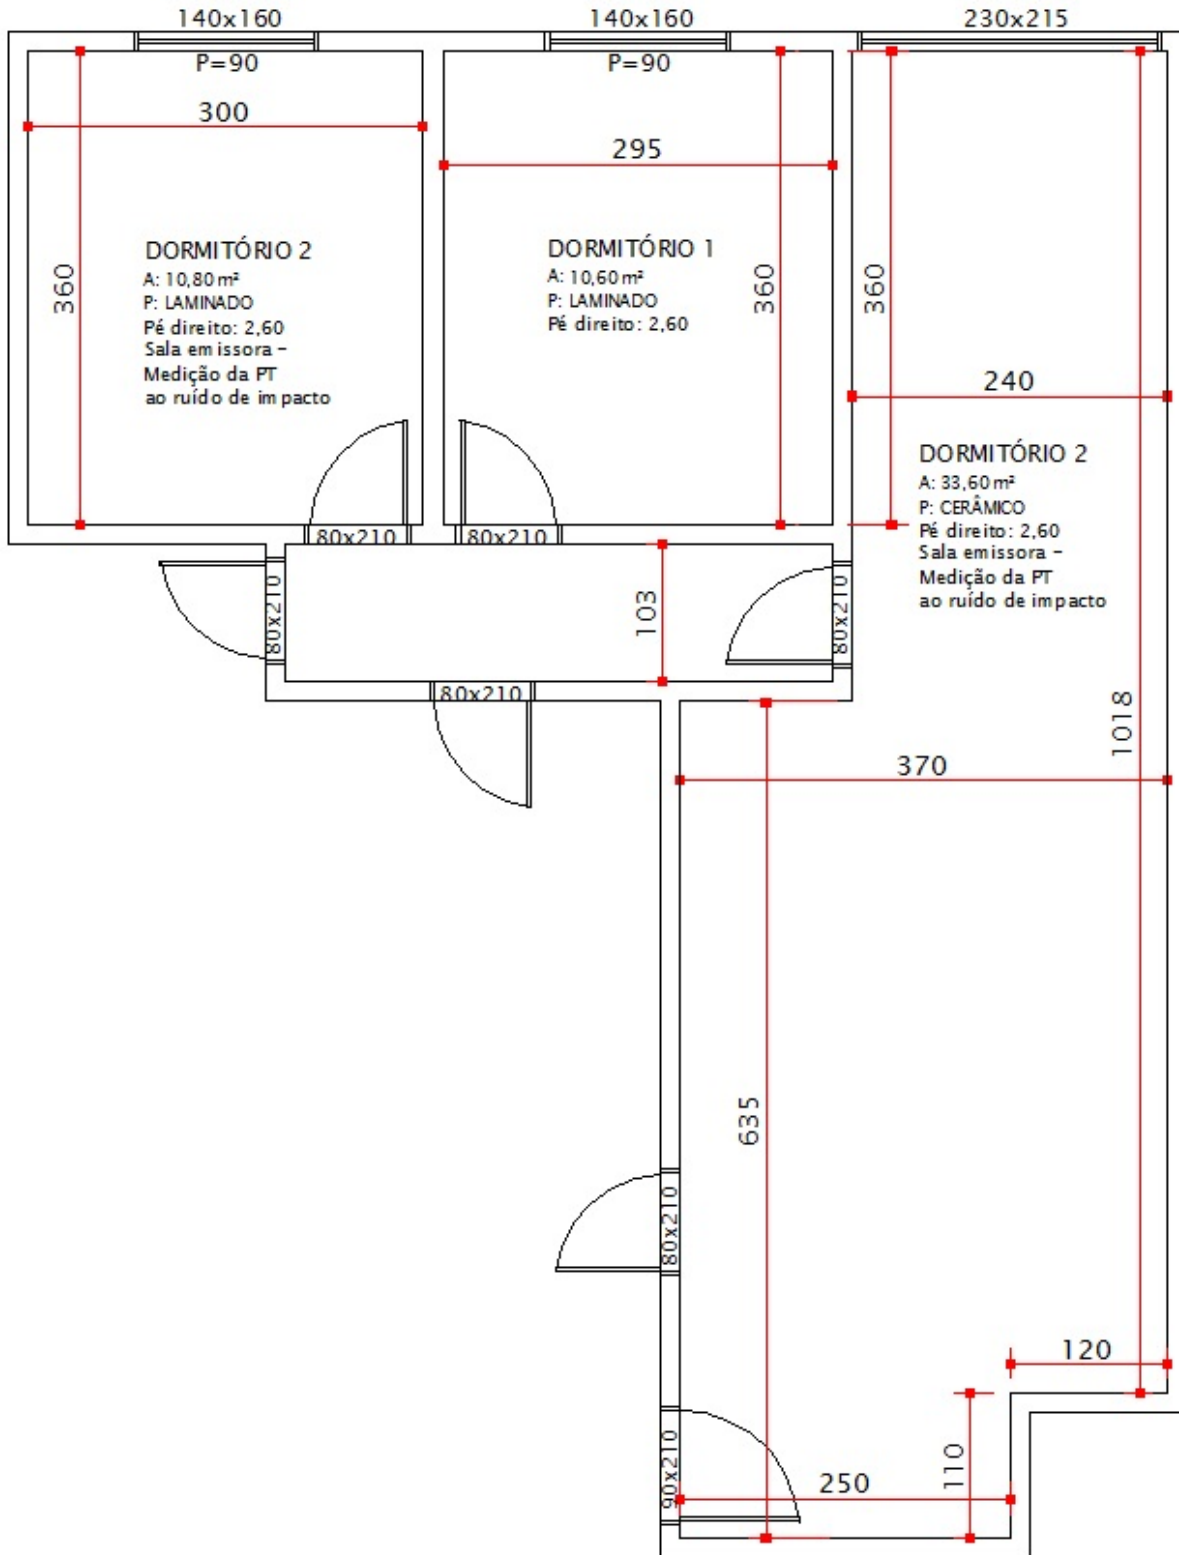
Planta baixa - pavimento inferior - 06-R8-N-PC-PL
